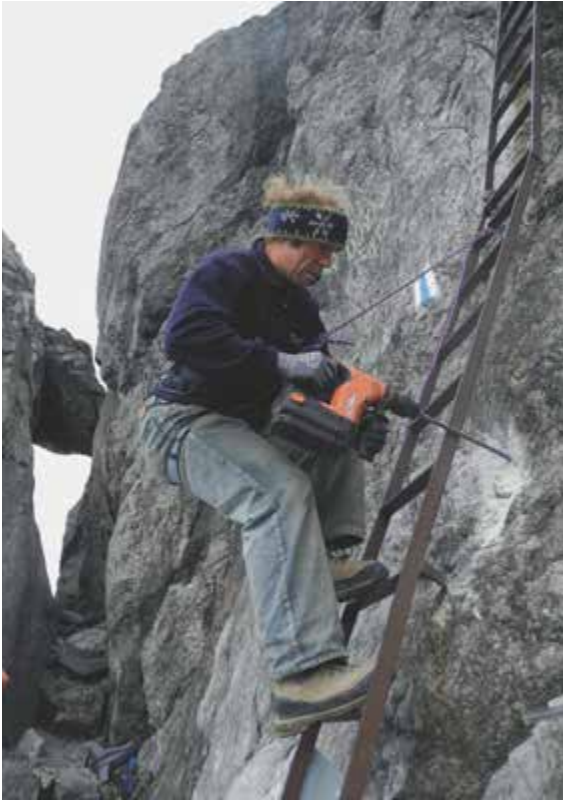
An exponierten Routen wie dem Drei Schwestern-Steig sind neben der laufenden Instandhaltung wiederholt auch größere Sanierungsarbeiten erforderlich (Foto OeAV-Bezirk Feldkirch)
